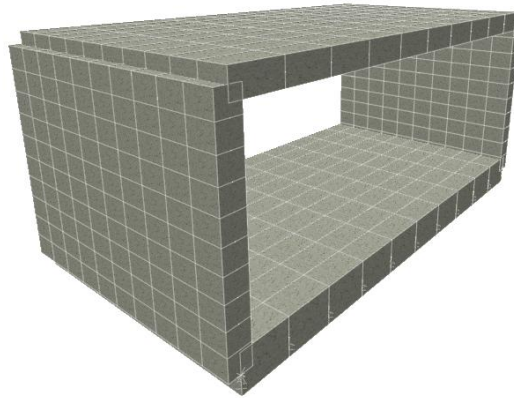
Modelo Box Culvert 2 en SAP 2000.
